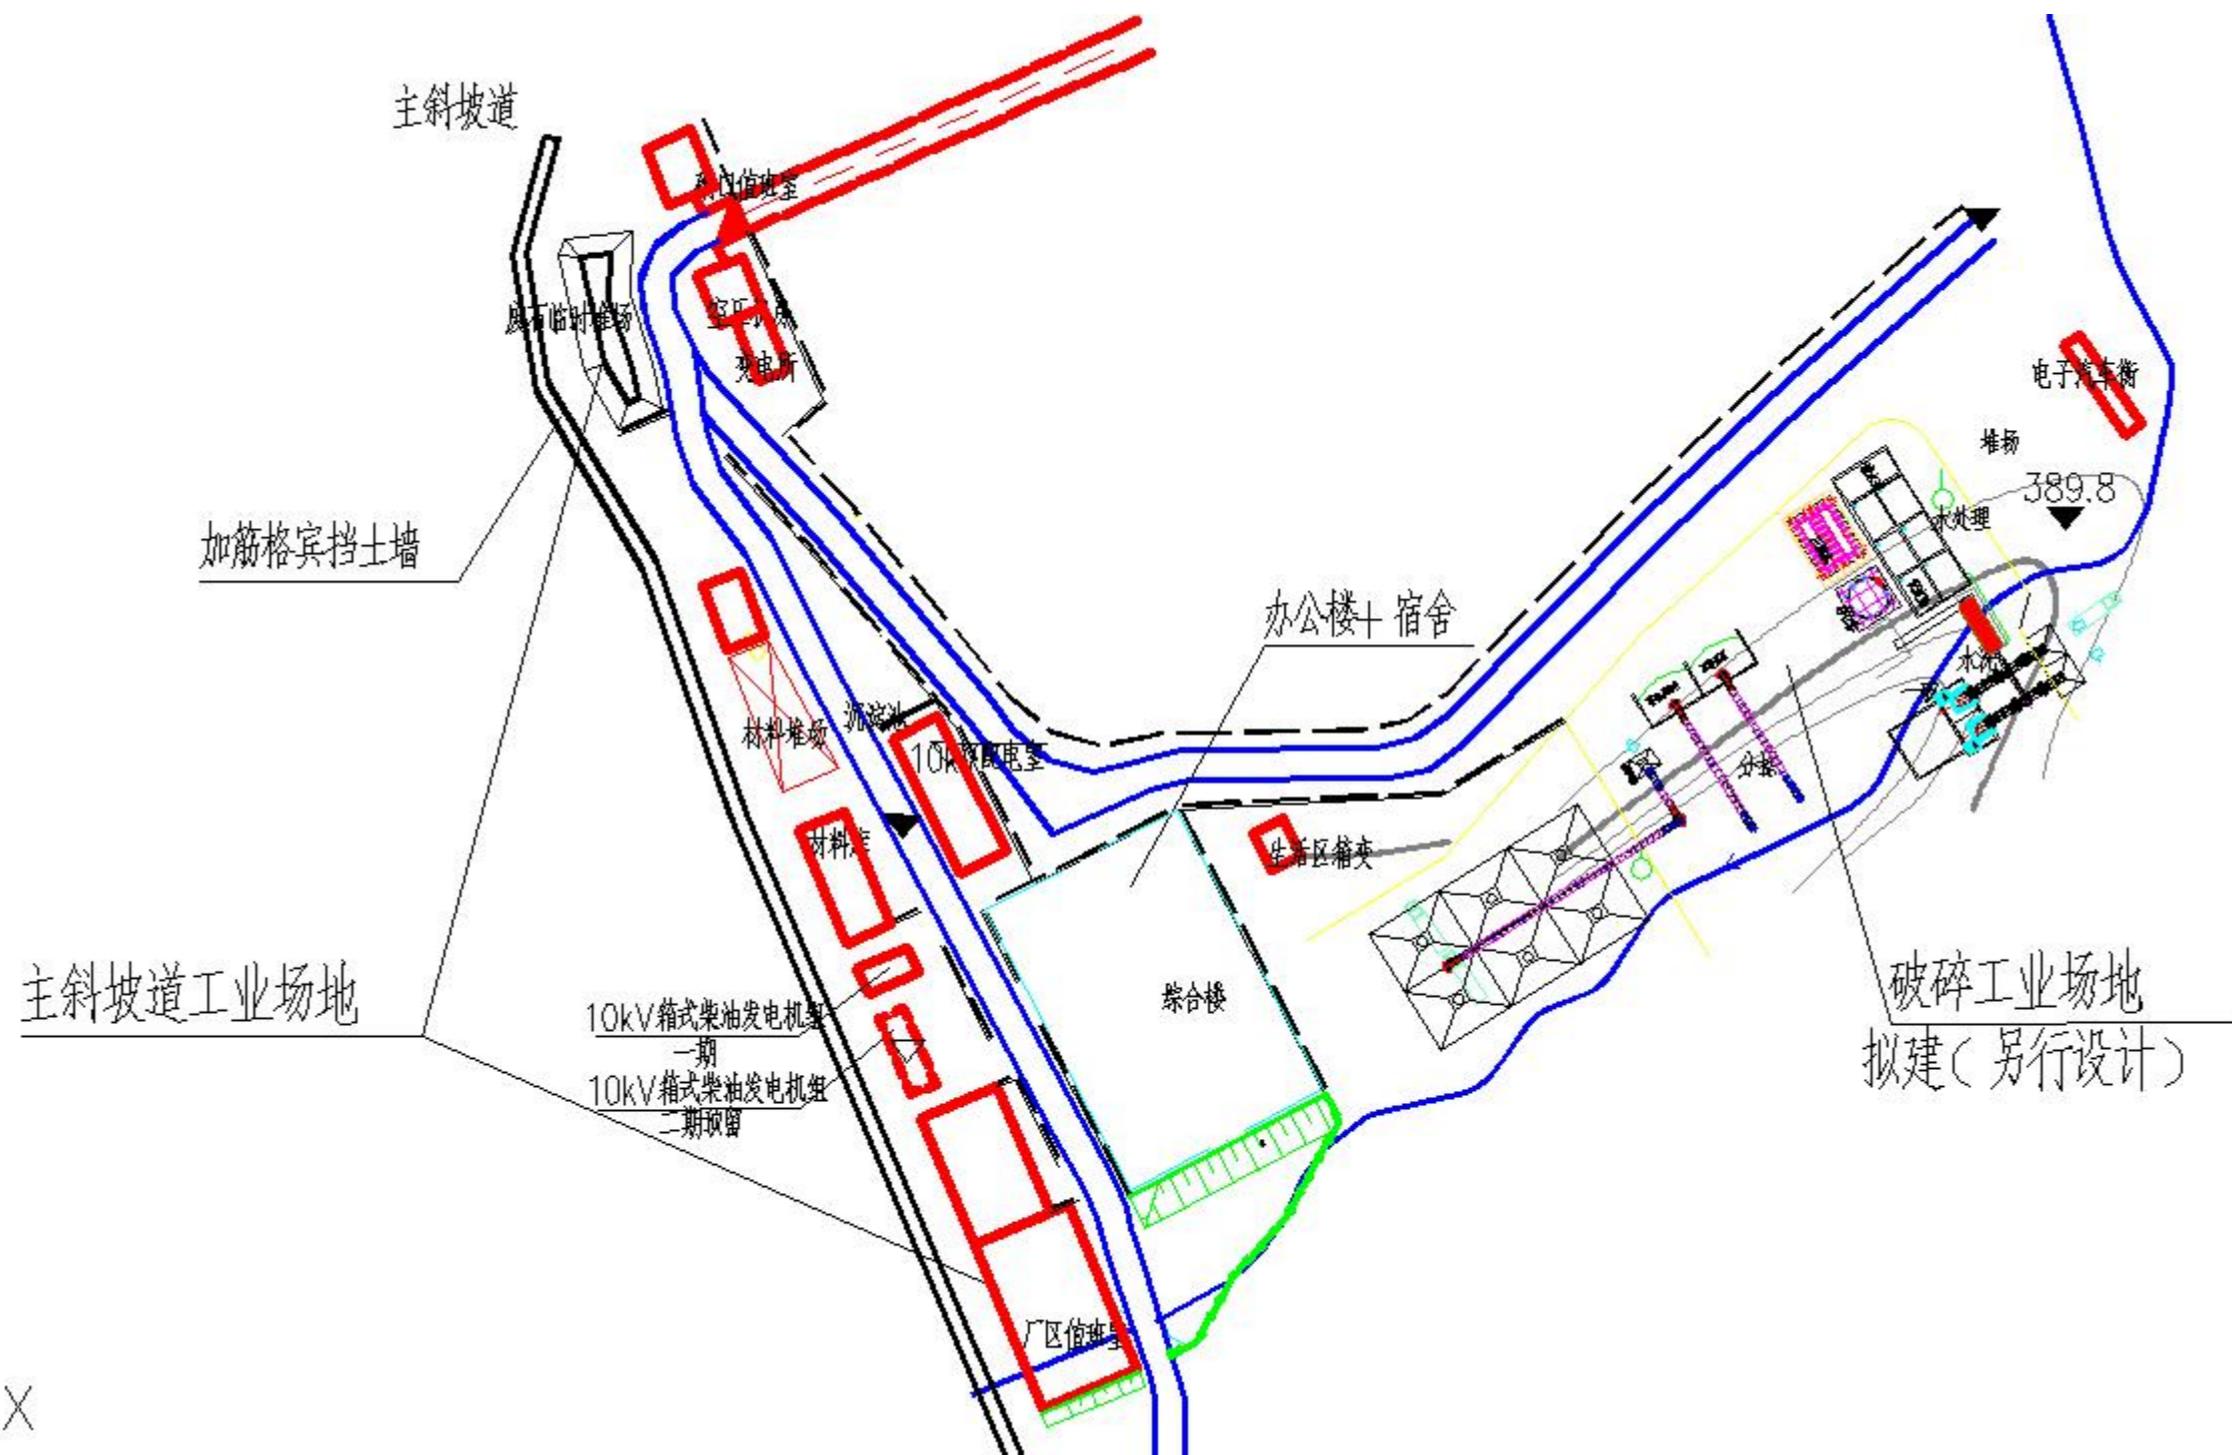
项目综合平面图局部一（主斜坡道工业场地）
